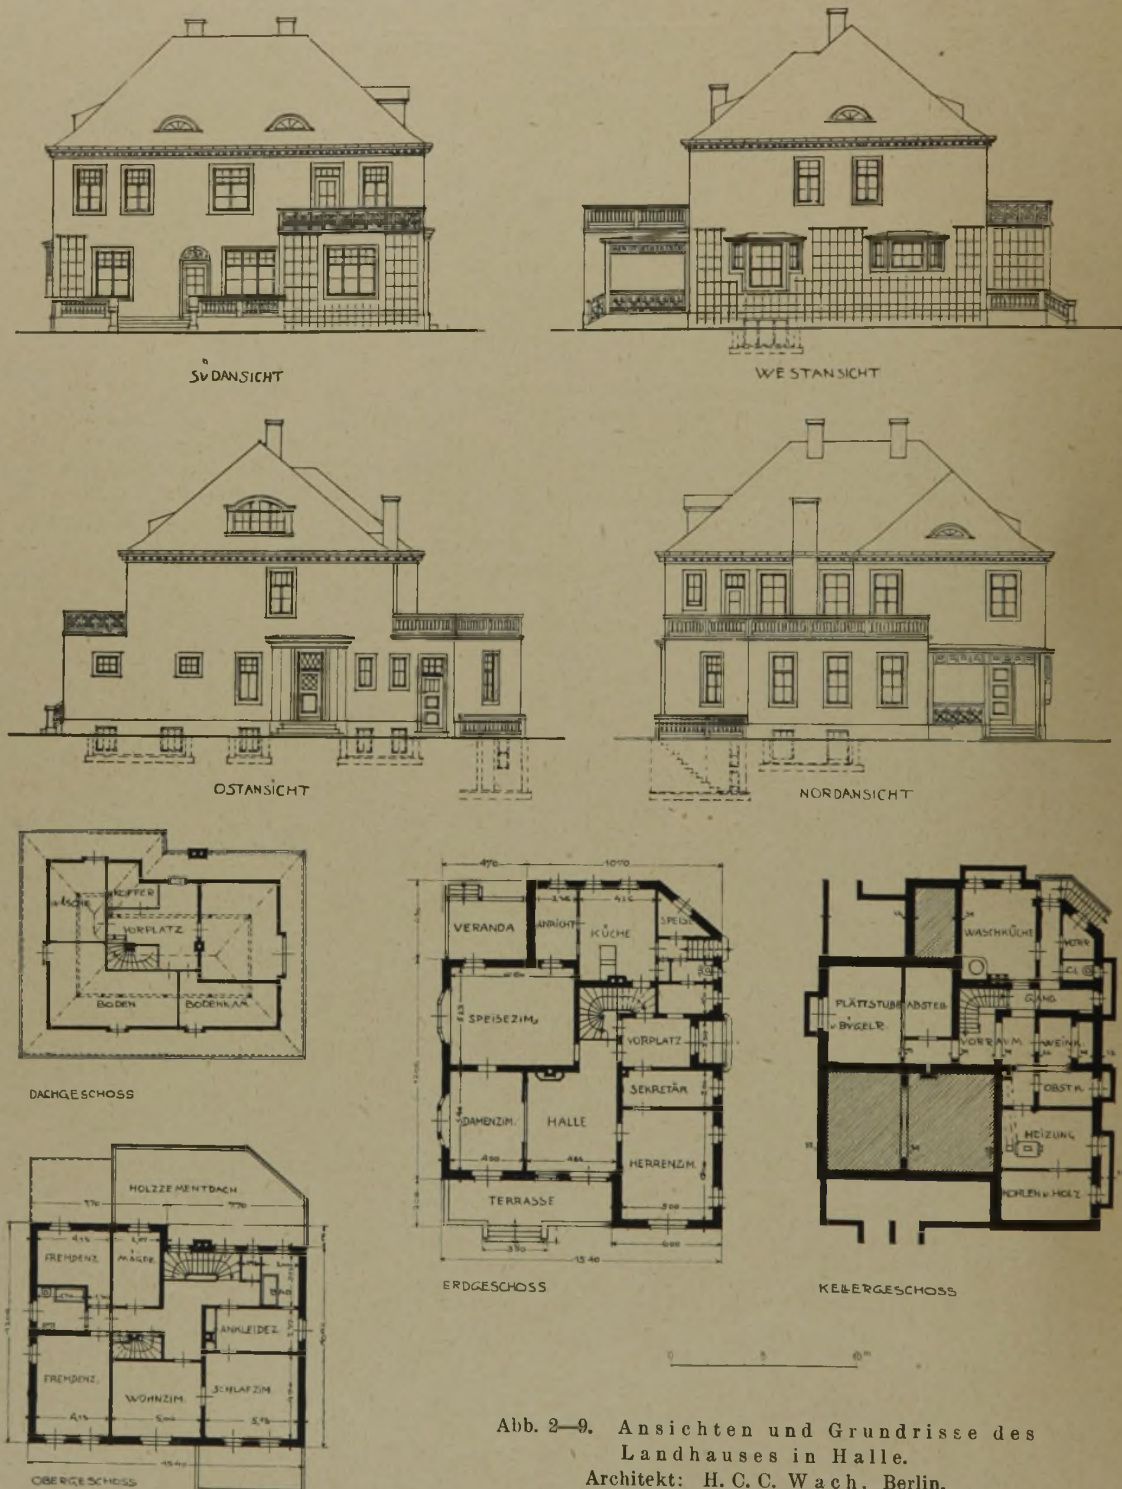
Ansichten und Grundrisse des Landhauses in Halle.
